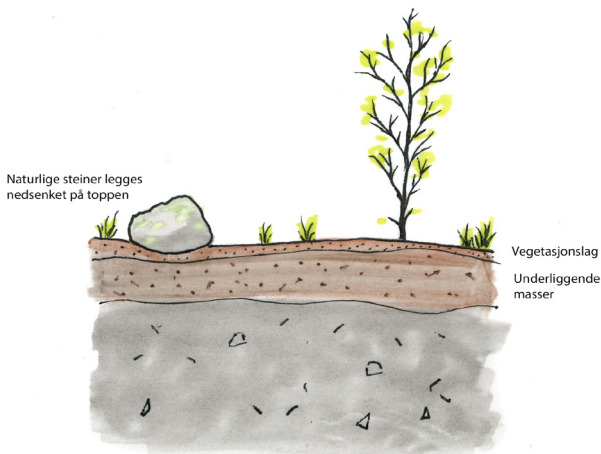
Godt tilbakeført fundament. Overgang mellom fundament og omliggende terreng er ivaretatt på en naturlig måte. Overflaten er rufsete og godt tilrettelagt for naturlig revegetering.
